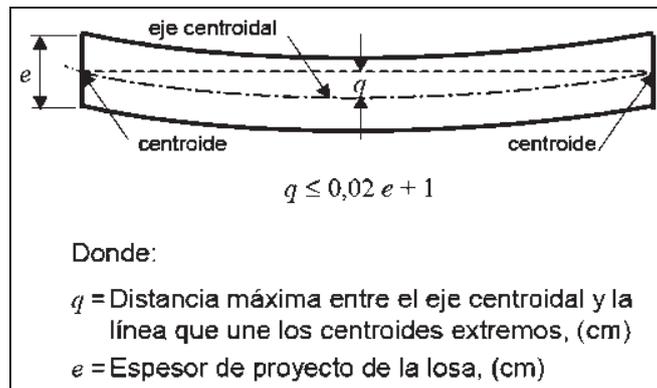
Tolerancia para el pandeo de losas [16].
